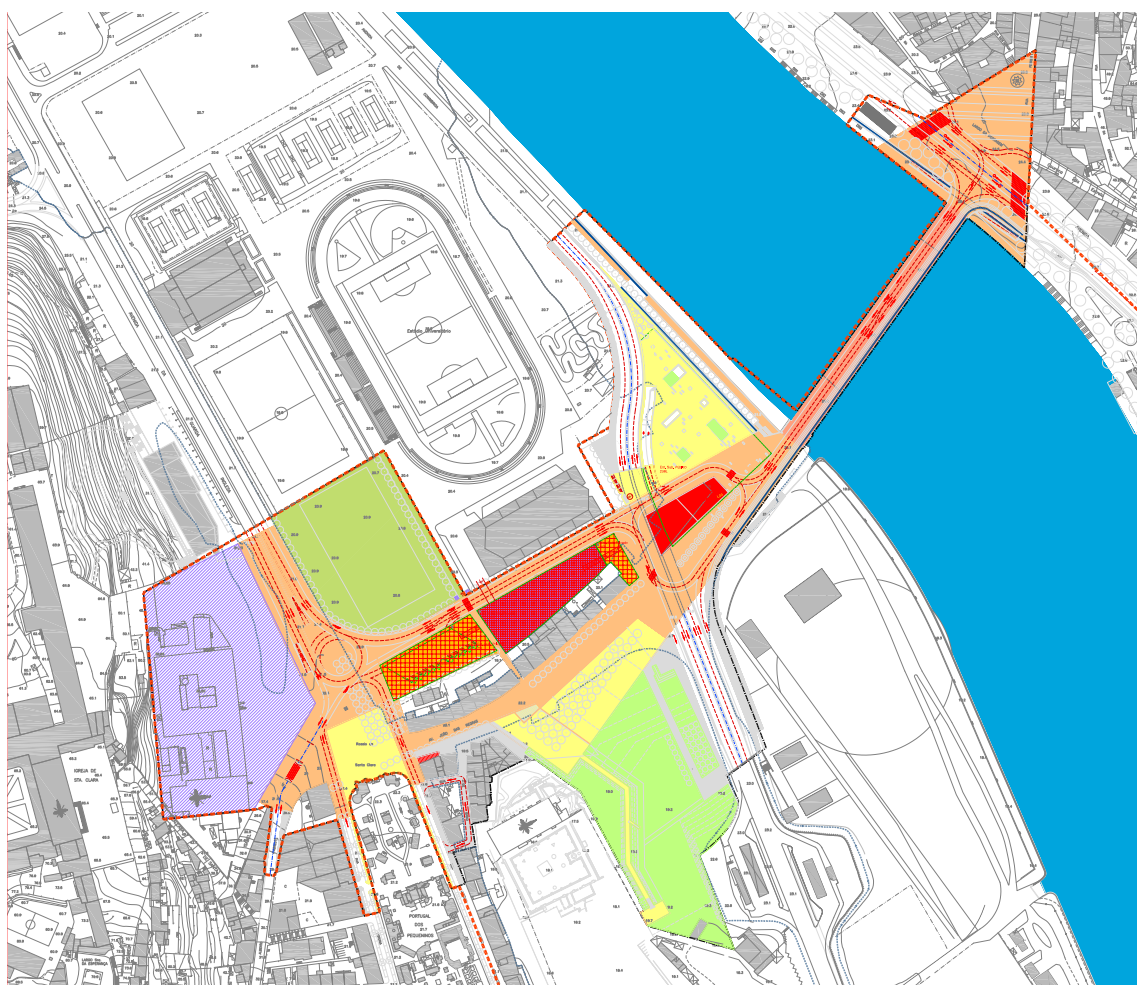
Planta do Plano de Pormenor do Eixo Portagem/Av. João das Regras - Gonçalo Byrne
